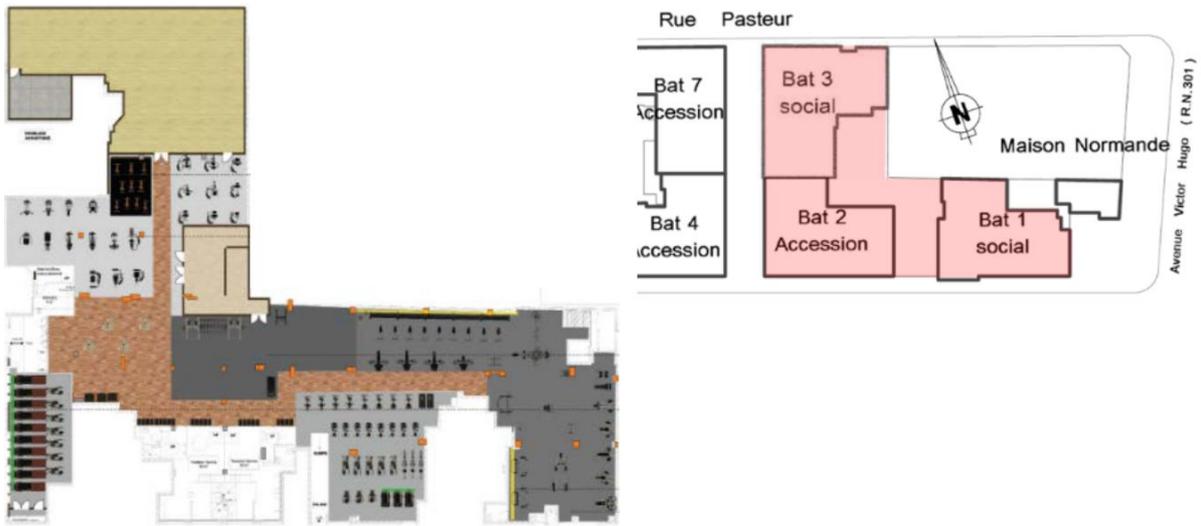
Plan d'aménagement du club au RDC Bat 1, 2 et 3
